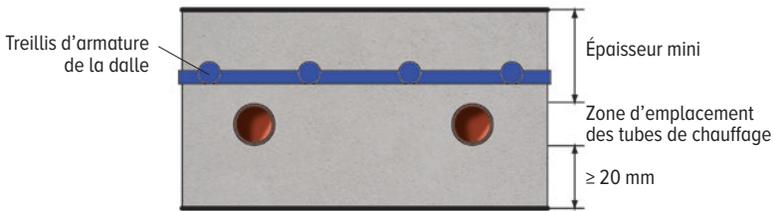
Dalle pleine (épaisseur > 20 mm)
